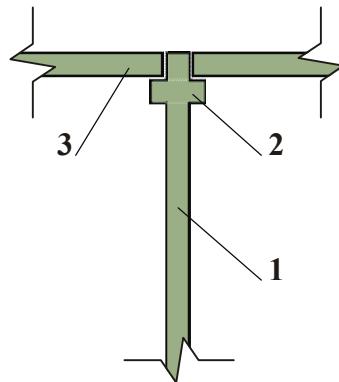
Конструкція перекриття по несучих залізобетонних перегородках:
